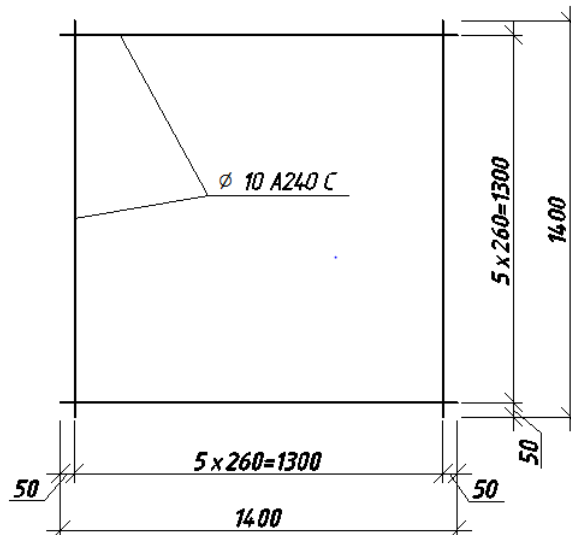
Конструювання стовпчастого фундаменту
